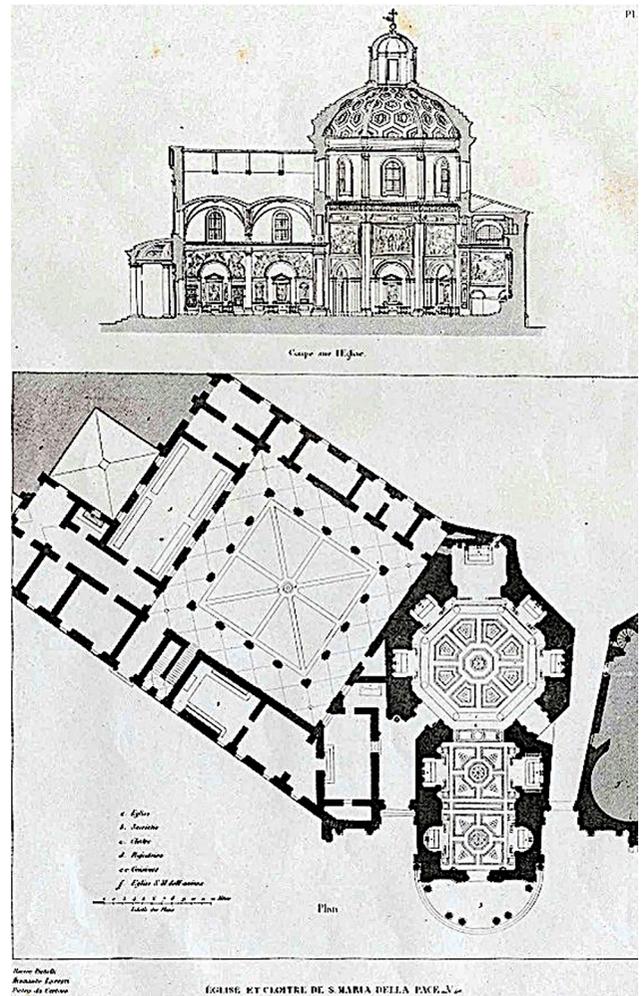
Il cortile bramantesco e la chiesa di S. Maria della Pace a Roma (LETAROUILLY 1849, planche 63).
